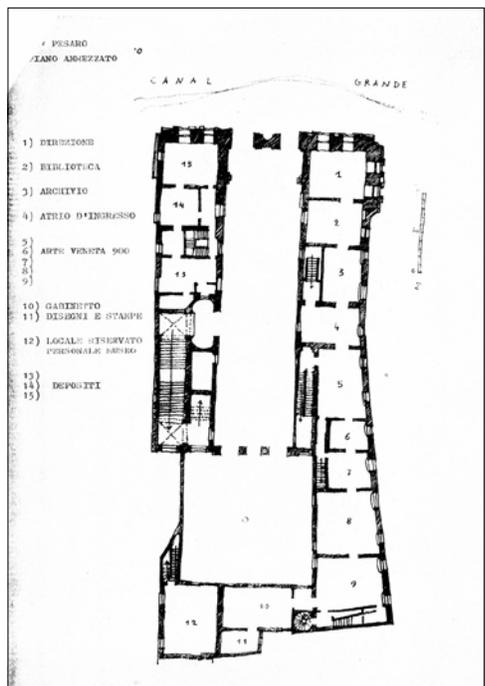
Planimetria dell'amezzato di Palazzo Pesaro. Venezia, Archivio Fondazione Bevilacqua La Masa, Ca' Pesaro
